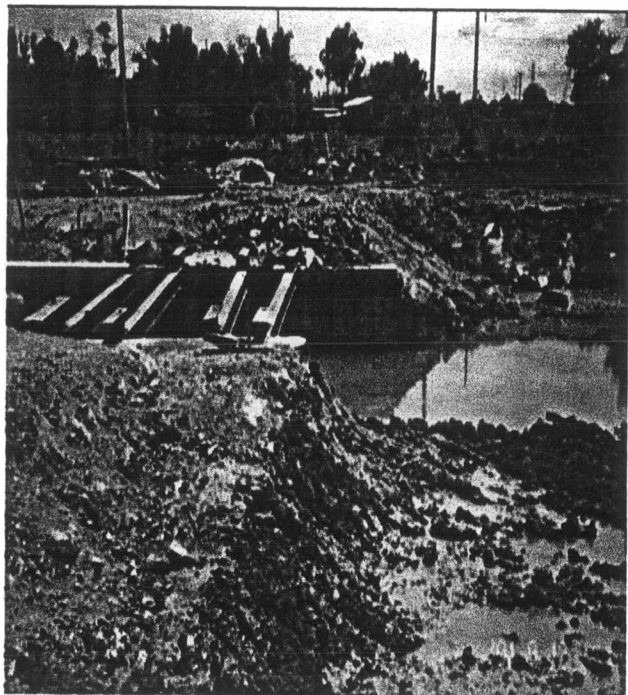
แสดงรอย Crack บริเวณด้านหลังของ Precast wall
